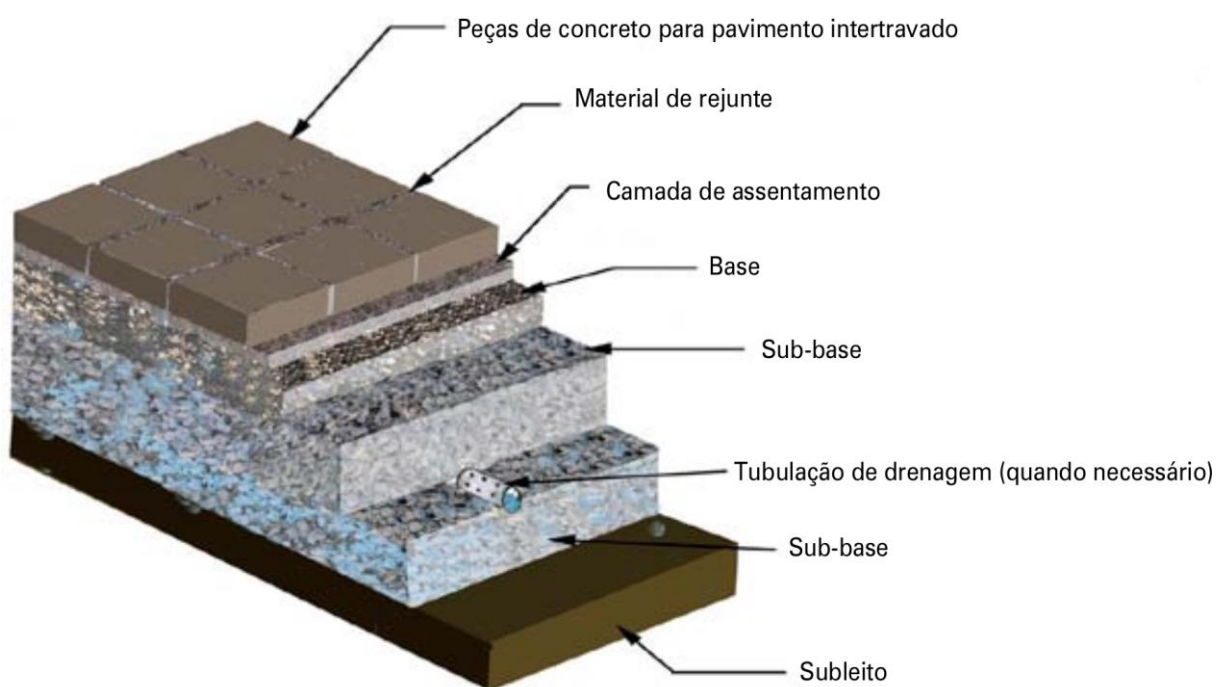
Seção-tipo típica de pavimento intertravado permeável.
